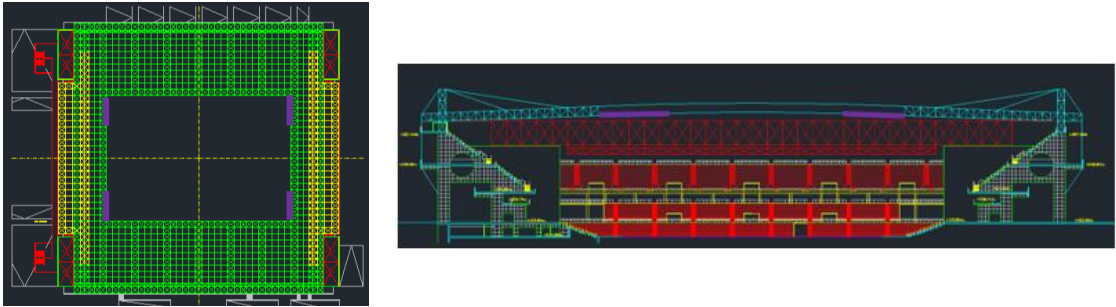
Ubicación proyectores en las esquinas de la cubierta de fondo.
